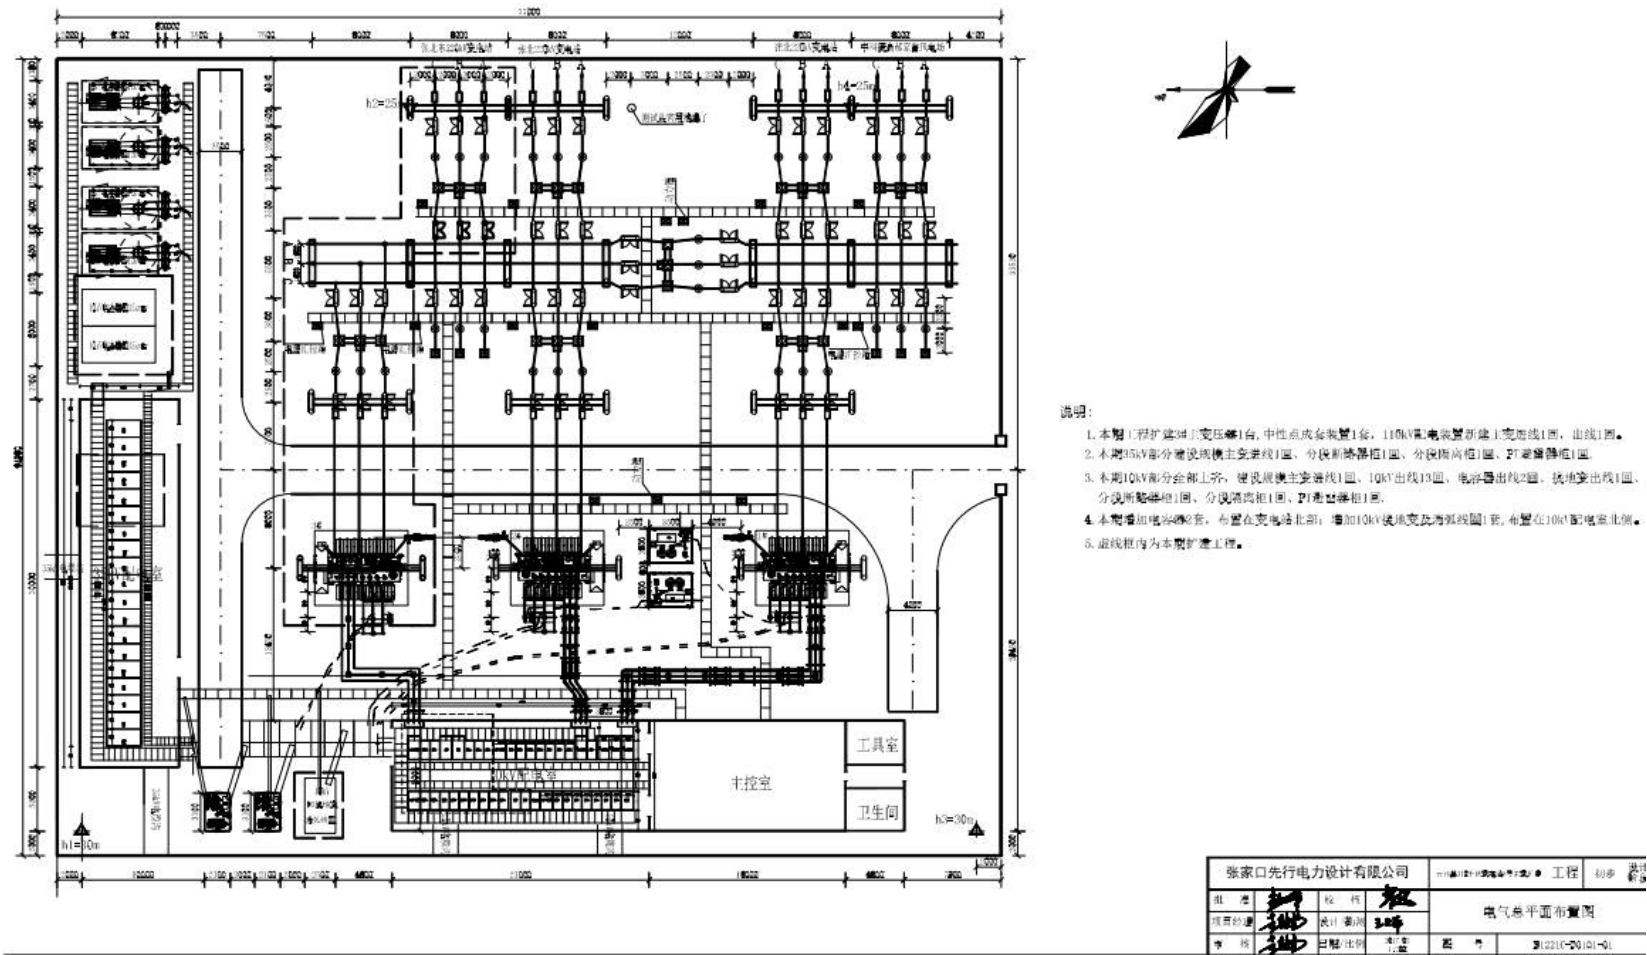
冀北张家口云计算 110kV 变电站电气平面布置图
